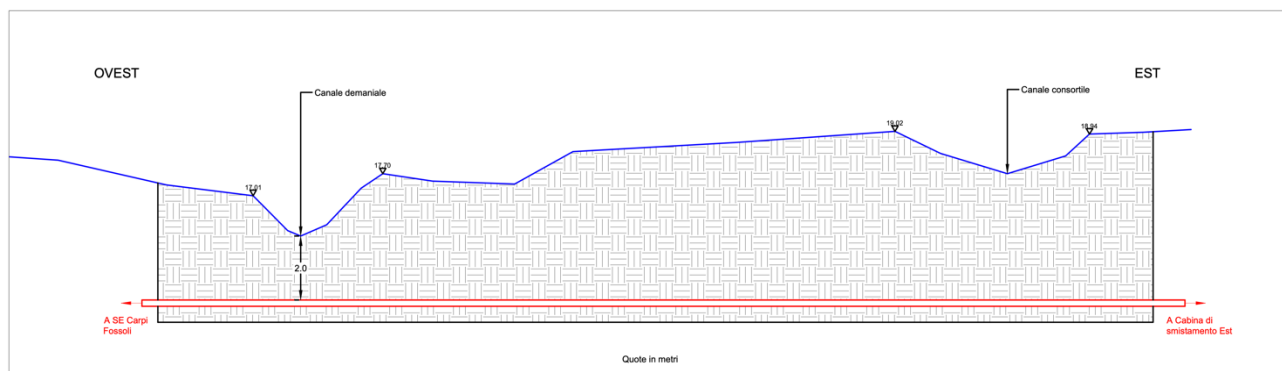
Sezione attraversamento canali demaniale e consortile (3-4)
